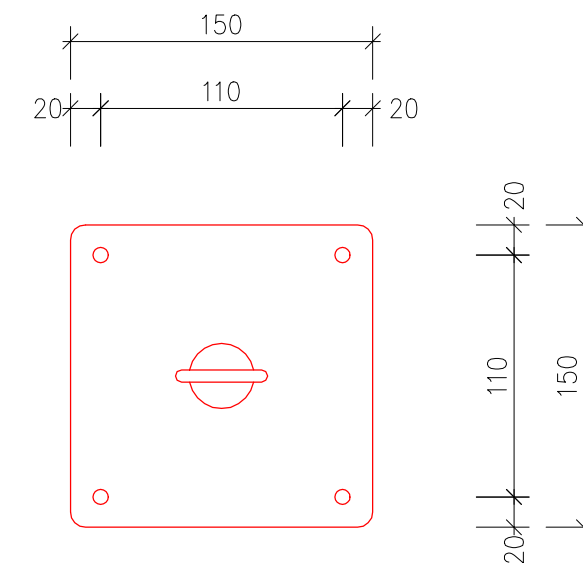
DETAIL G – OSAZENÍ KOTVÍČÍHO BODU – BETONOVÁ KONSTRUKCE, 1:10
